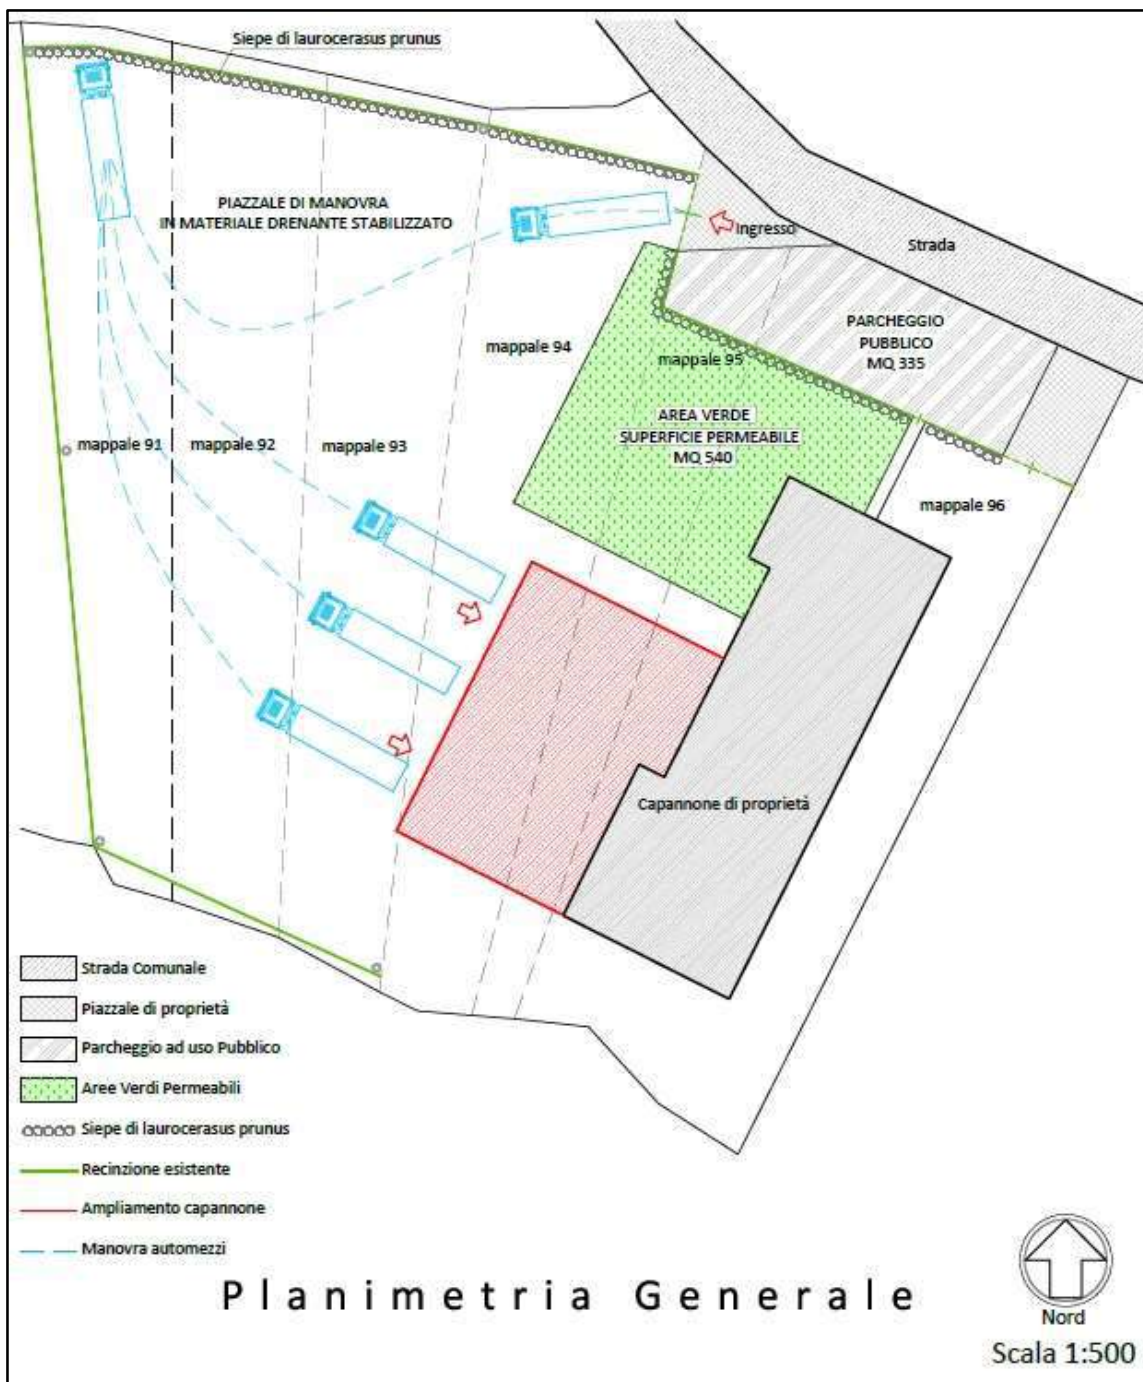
Stralcio dal progetto redatto dal Geom. R. Pulze
